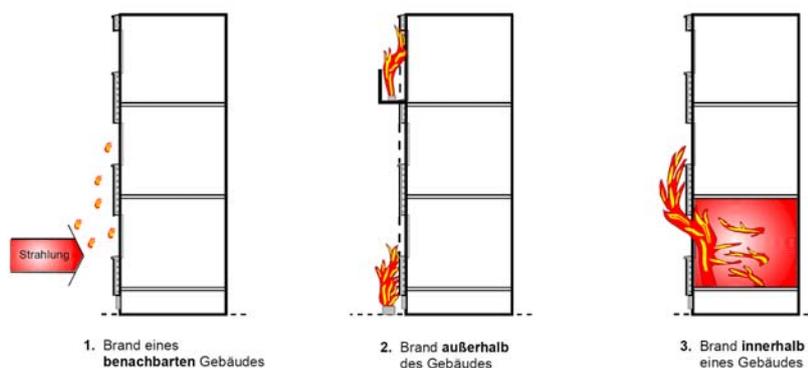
Brandbeanspruchung einer Fassade [D 9]
